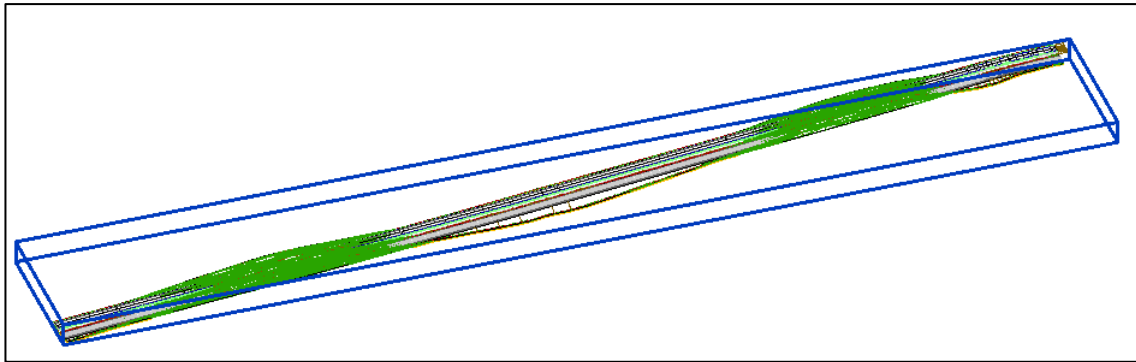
Modelo BIM 3D en Revit. Fuente: Elaboración propia
